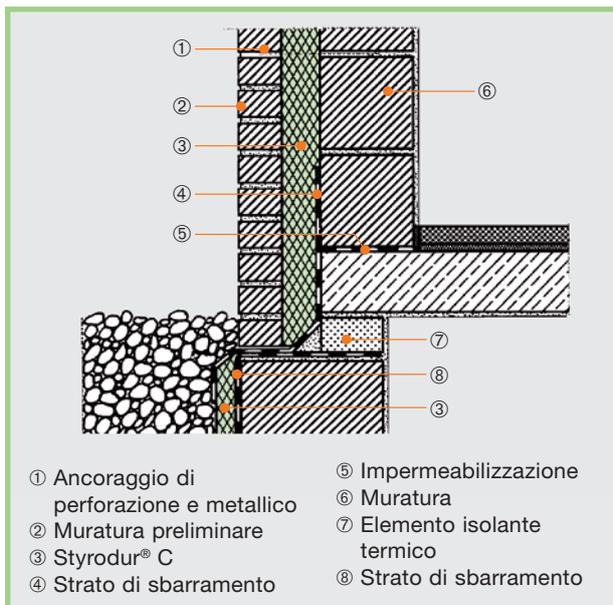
Allacciamento dell'isolamento perimetrale all'opera in muratura.
